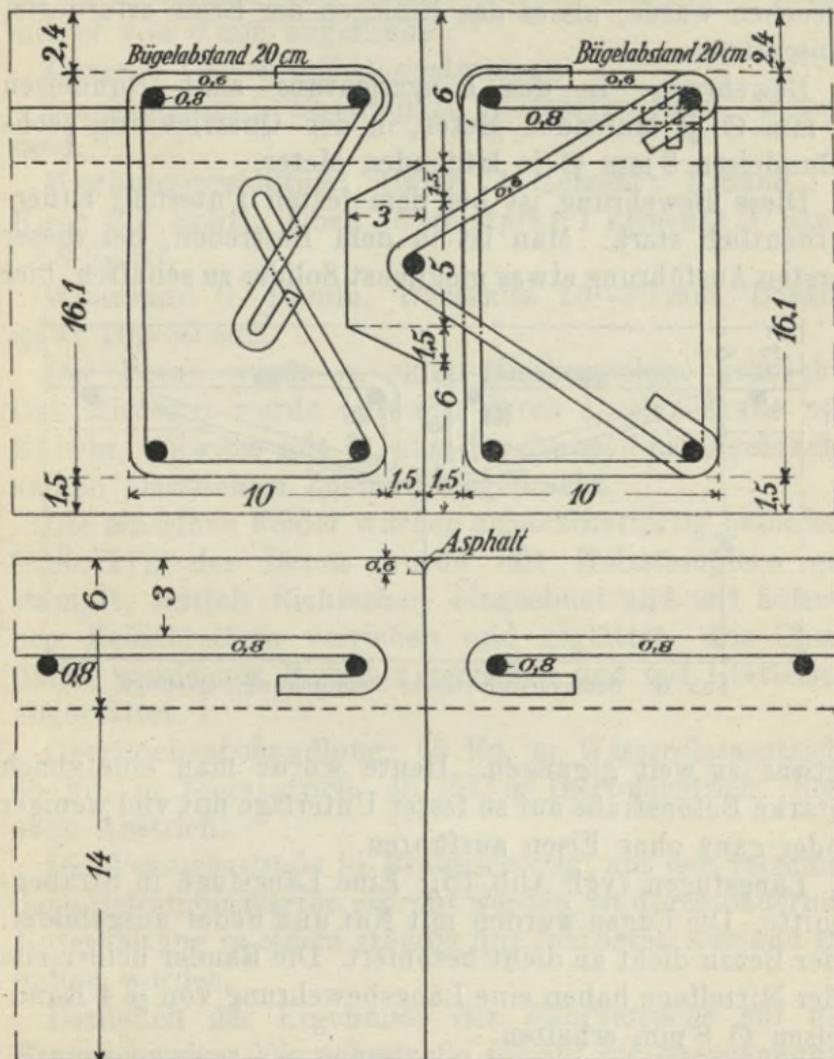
Betonversuchsstrecke Braunschweig. Mittelfuge und Querfuge (alle 6 m).
